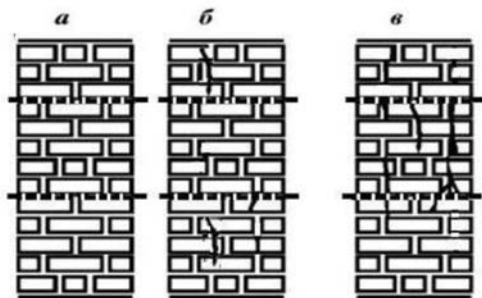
Стадии работы каменной кладки с поперечным армированием при центральном сжатии: а – первая; б – вторая; в – третья (разрушение)
